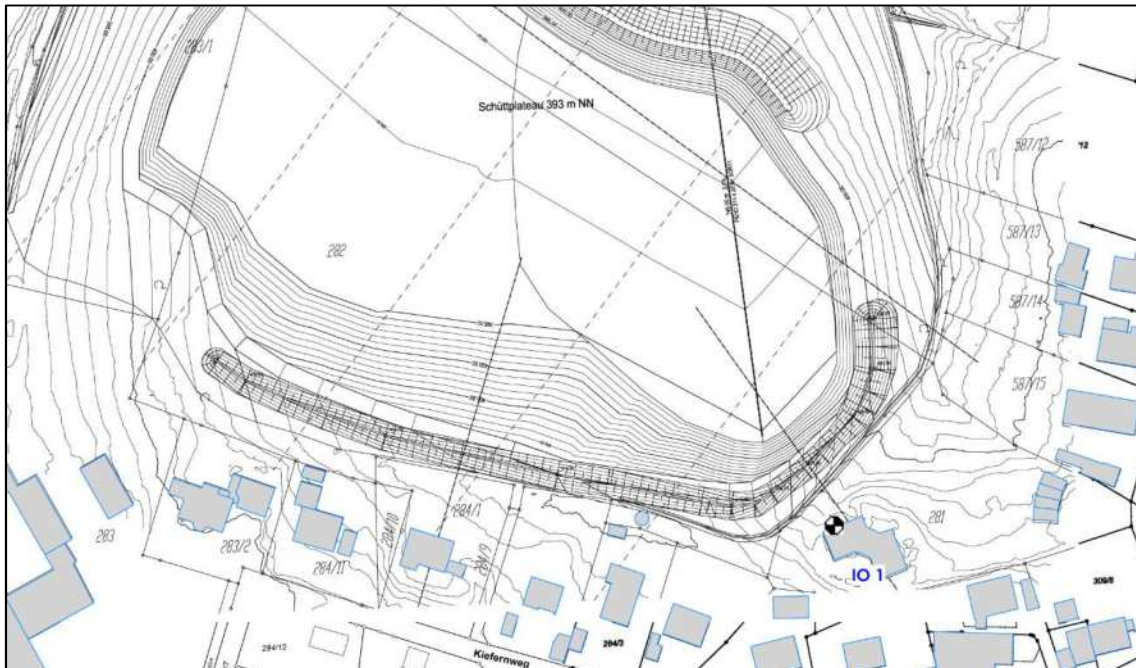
Lageplan mit Darstellung des maßgeblichen Immissionsorts (IO)
